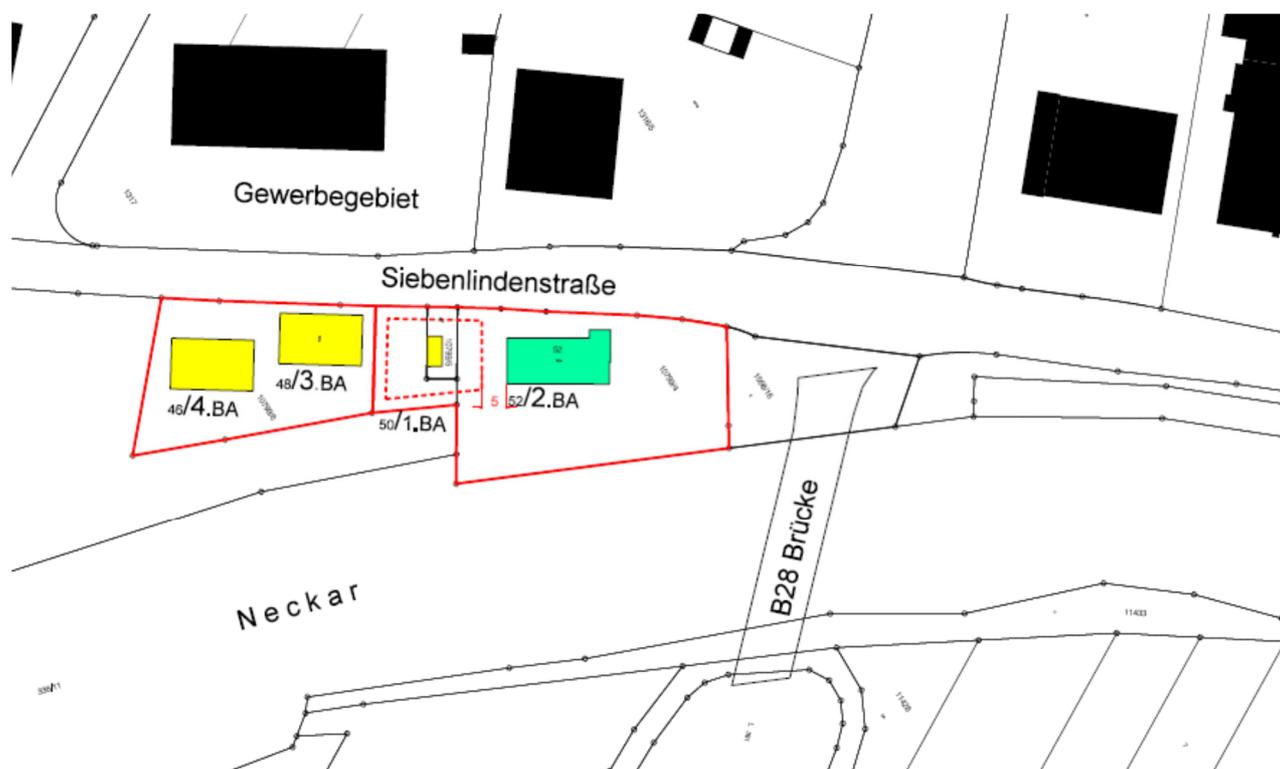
Lageplan (gelb=Abbruch; grün=Sanierung, Aufstockung)
